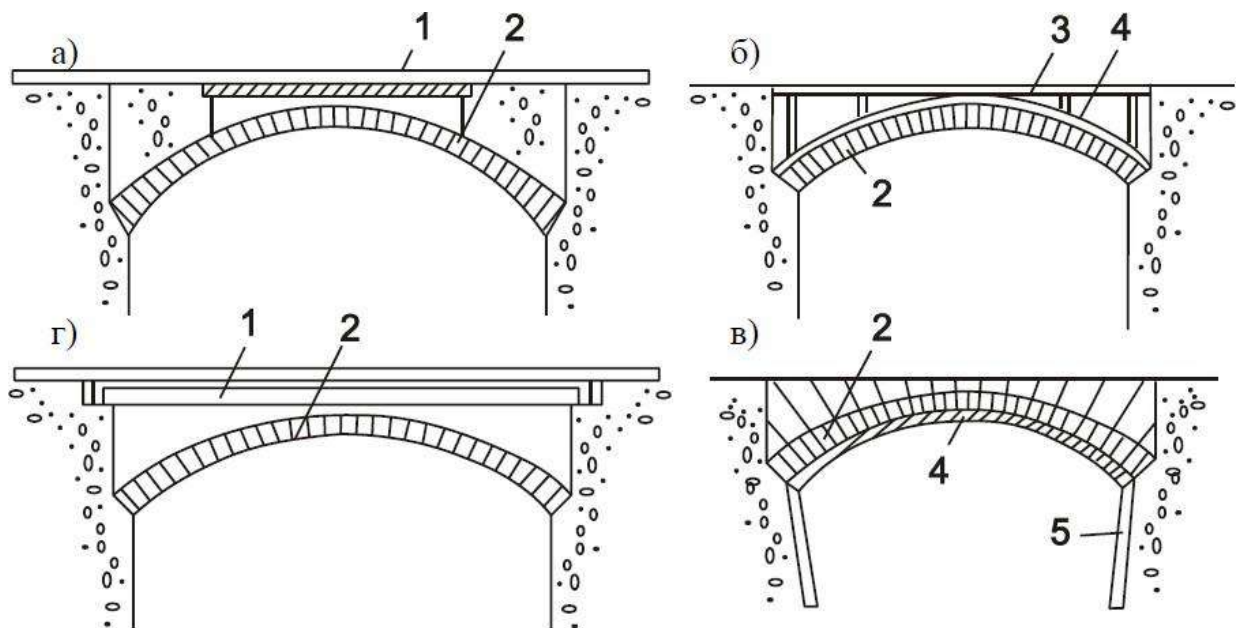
Схемы усиления сводов каменных и бетонных мостов:
